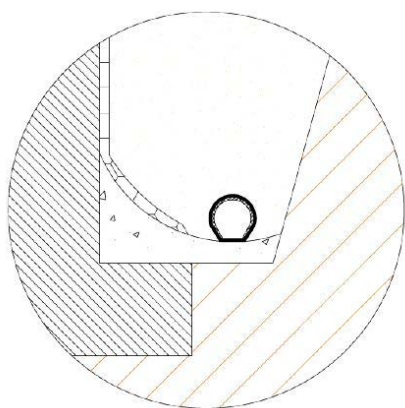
COUPE DE PRINCIPE D'UN ACCOTEMENT & D'UNE CUNETTE
